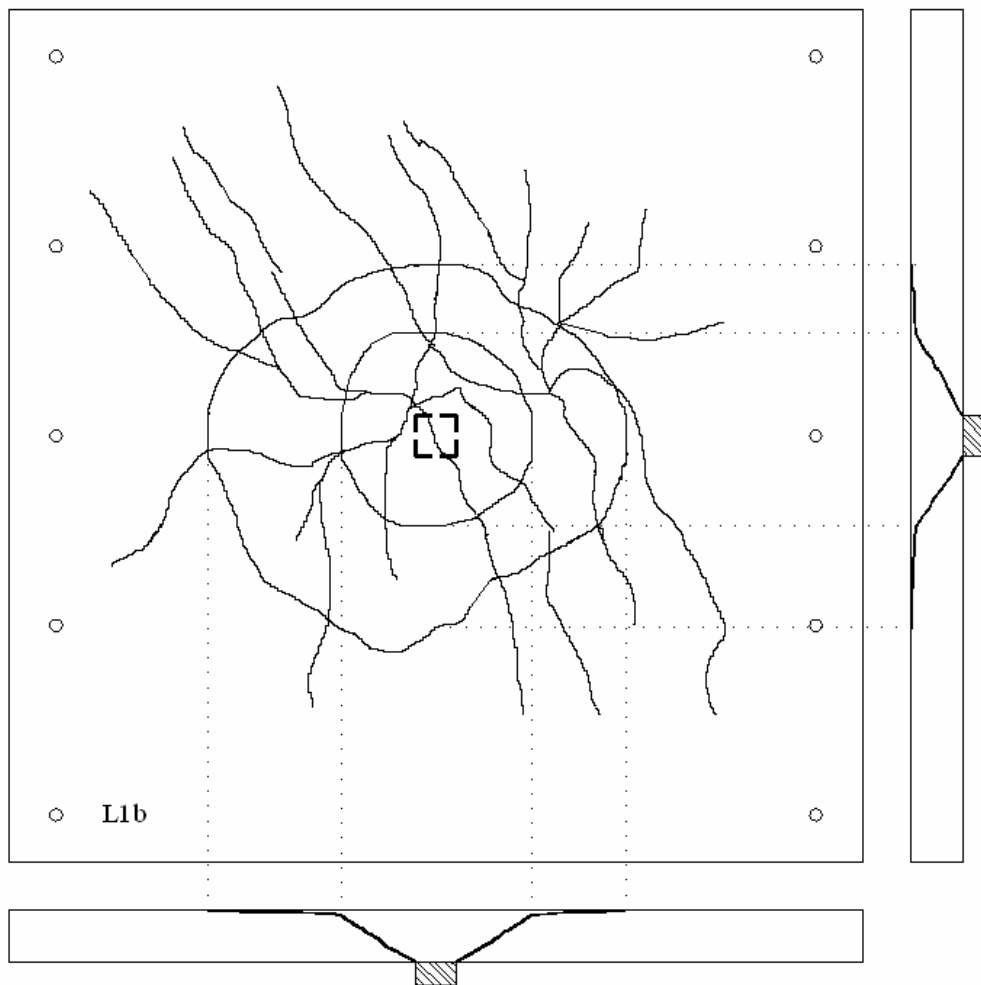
Mapa de fissuração da laje L1b
